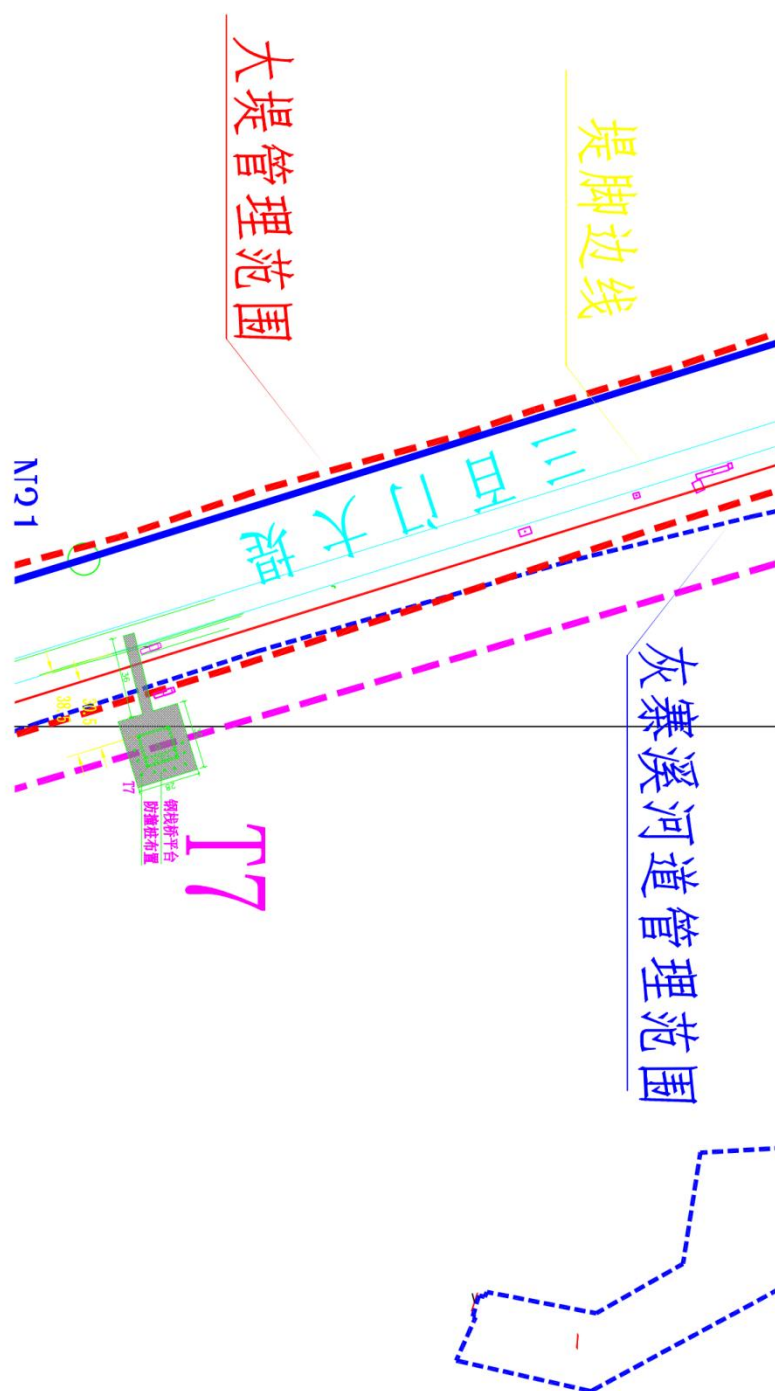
塔基 T7 占用河道管理范围平面示意图
